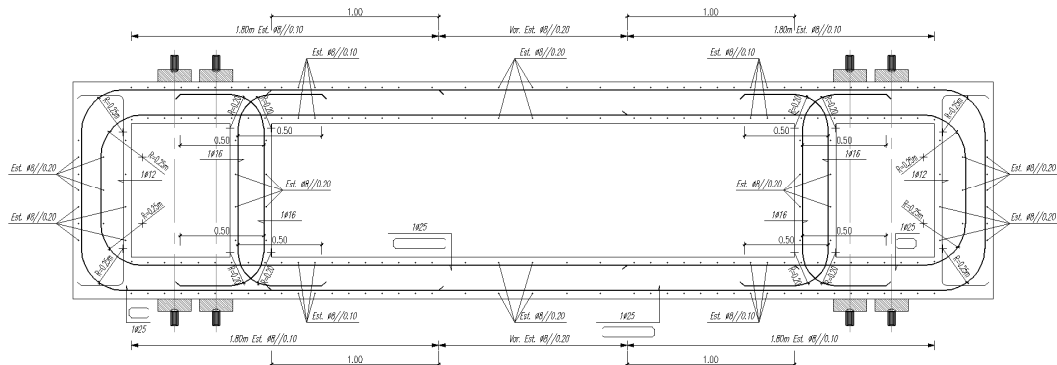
Execução de nova travessa para interligação dos montantes dos pilares e para apoio dos macos hidráulicos utilizados para a transferência provisória de carga, até à instalação dos novos apoios. Vista da travessa executada e da planta de armaduras da viga.
